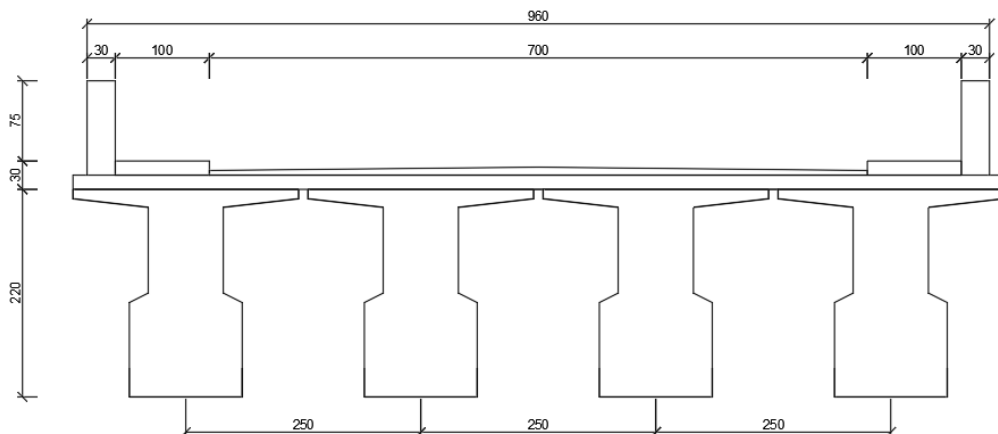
3 Tampak Depan Penampang Tee Girder Bagian Lapangan dan Tumpuan
